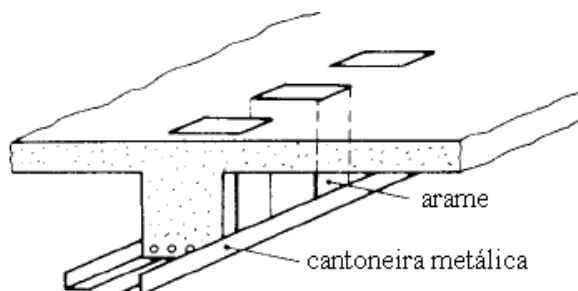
Reforço de uma viga com cantoneiras metálicas (Somensi, 2007)
